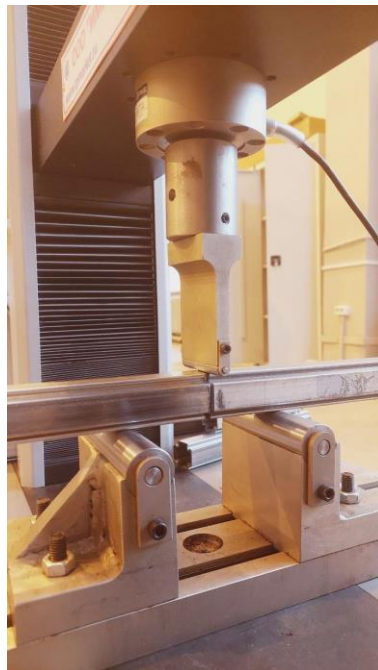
Общий вид образца торцевого соединения (штулки)
